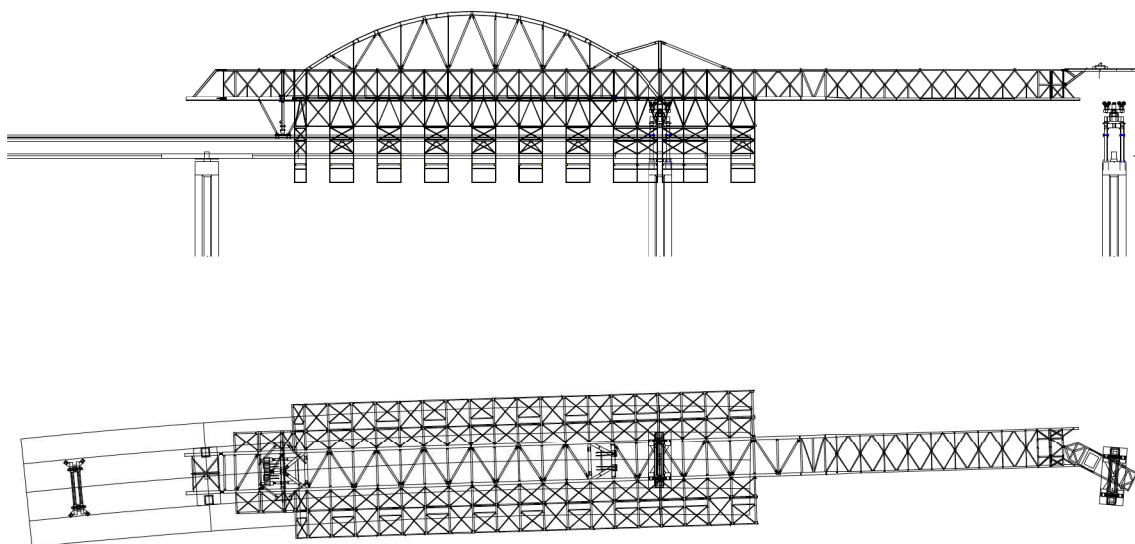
Autocimbra sobre tablero para vanos de 62 m de luz: alzado (arriba) y planta (abajo)
